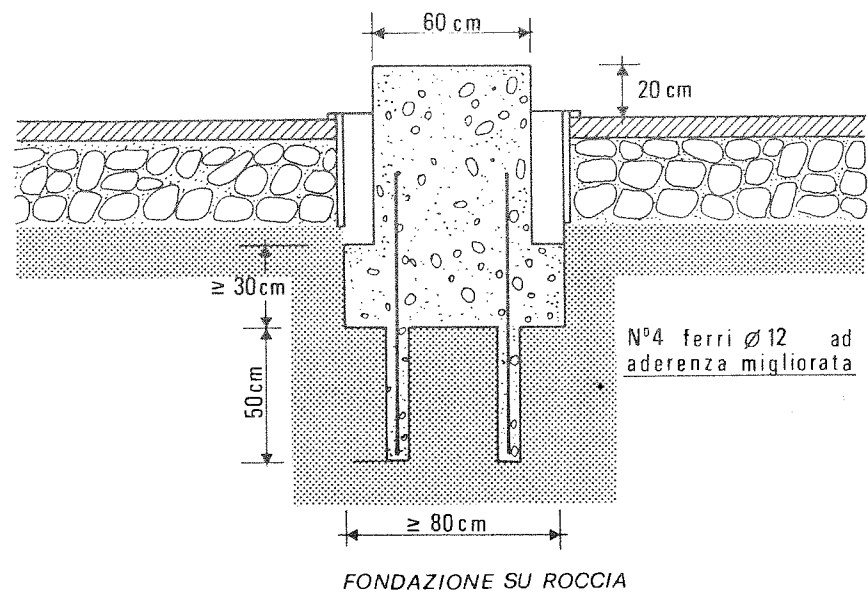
Fondazione del pilastro di ancoraggio dell'accelerografo.
